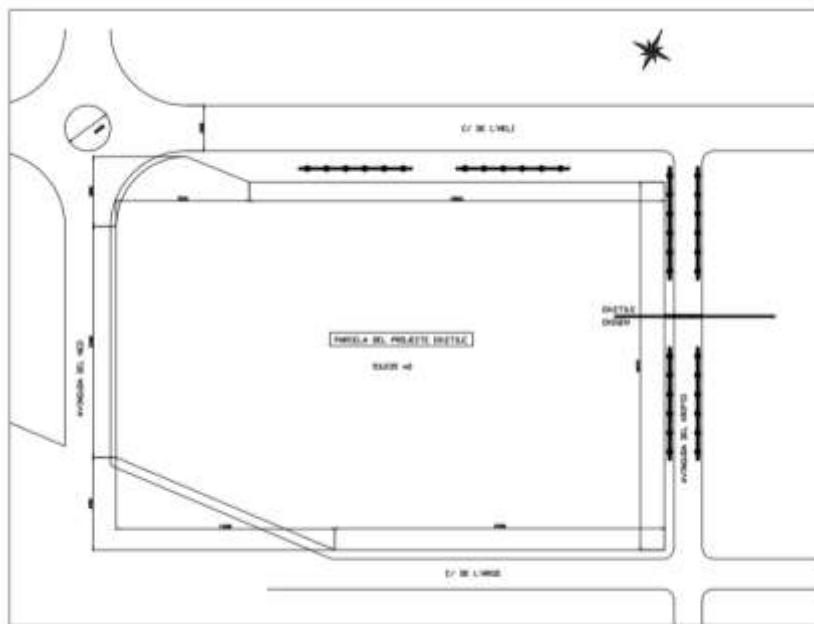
Plano de la parcela destinada a la construcción de la planta.
